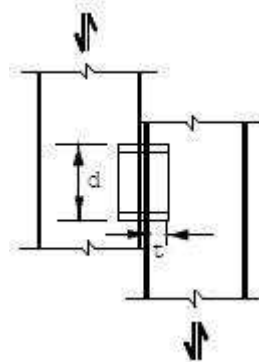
Conexão com anel metálico utilizado nas ligações de vigas principais e secundárias
